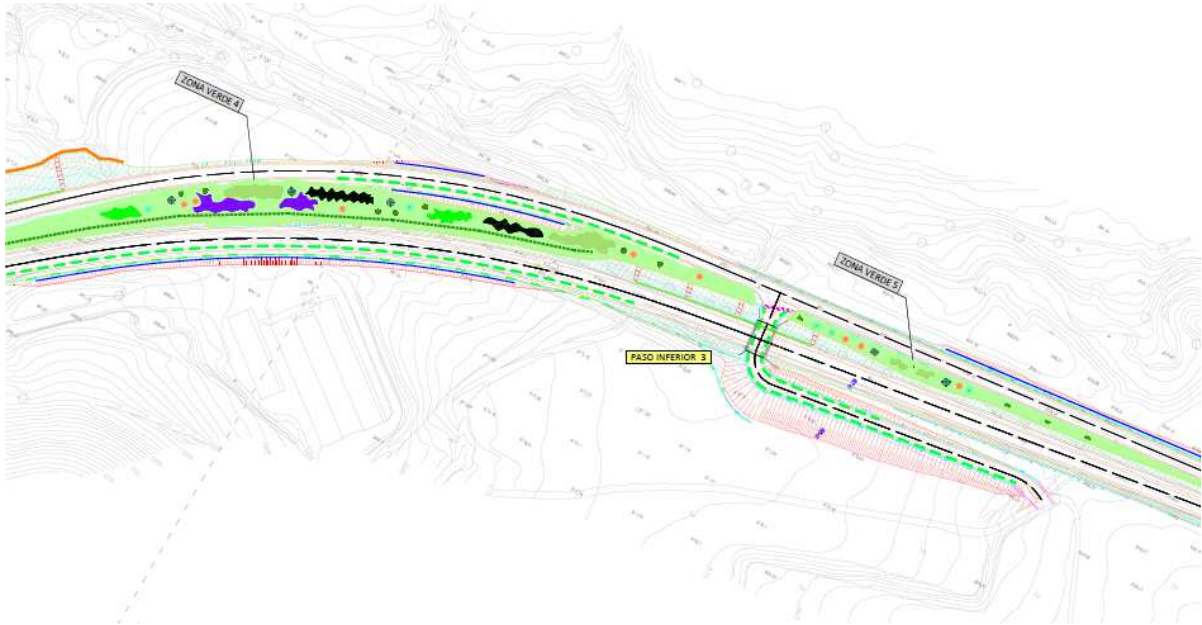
Zonas 4 y 5 de revegetación. Fuente: Elaboración propia.
